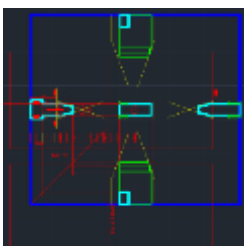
Planta y elevaciones. Fuente: elaboración propia.
